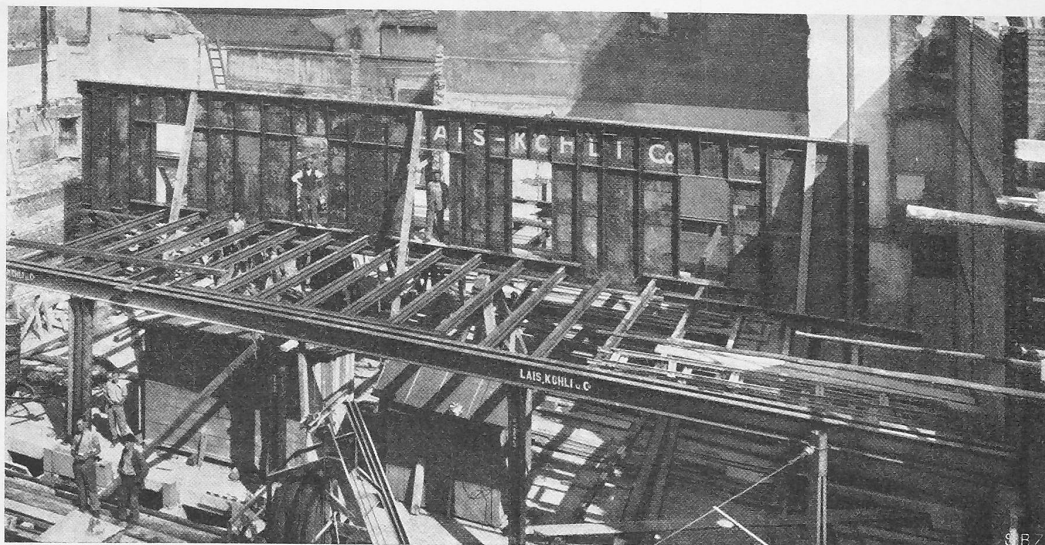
Ansicht des fertig montierten 3,73 m hohen Wandträgers von 19,76 m Stützweite.
